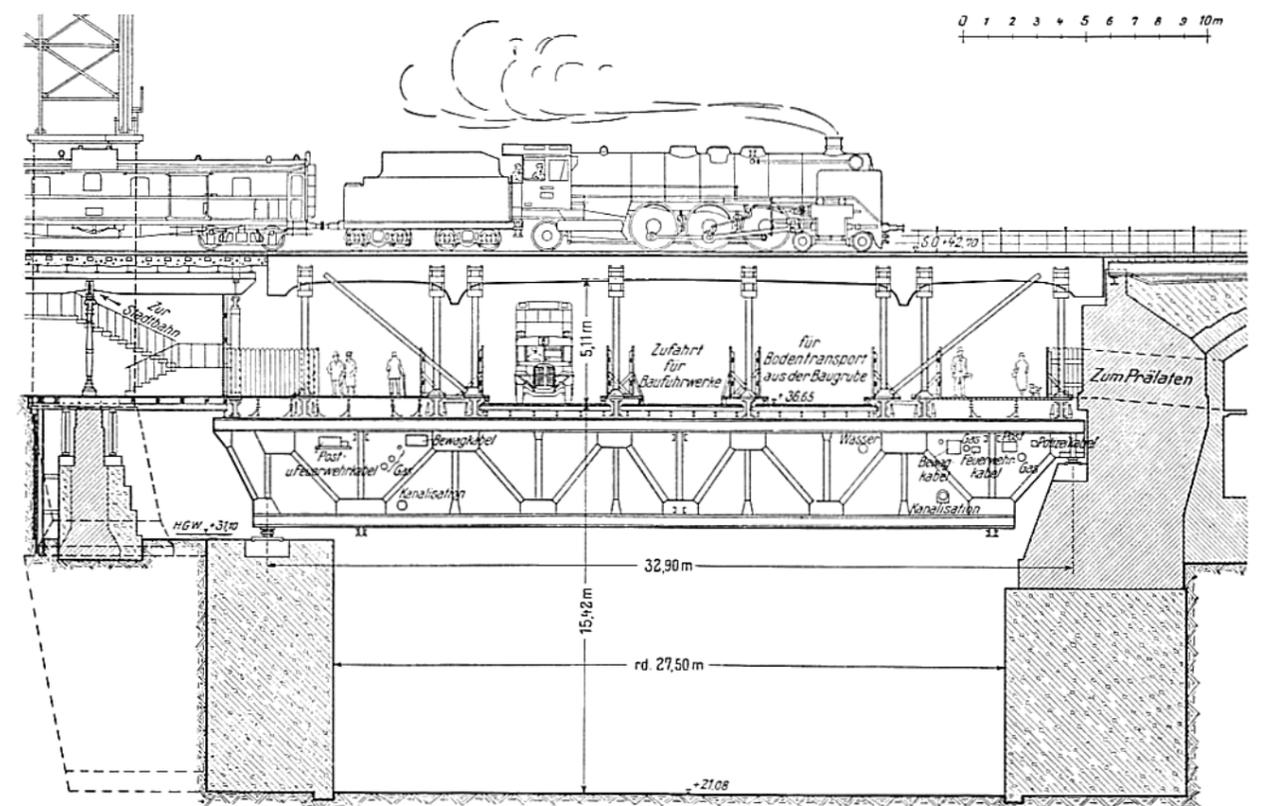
Stadtbahnüberführung in der Königstraße. Aushub der Tunnelbaugrube unter der Gerüstbrücke.
